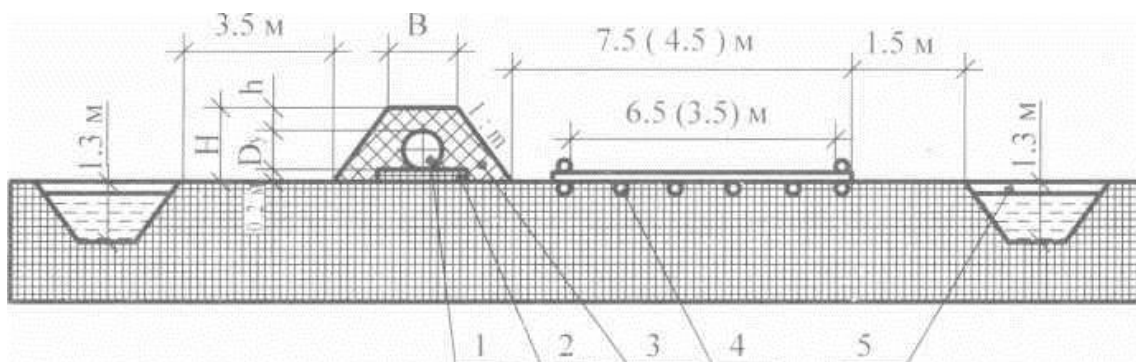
Схема прокладки трубопровода наземно в насыпи:
